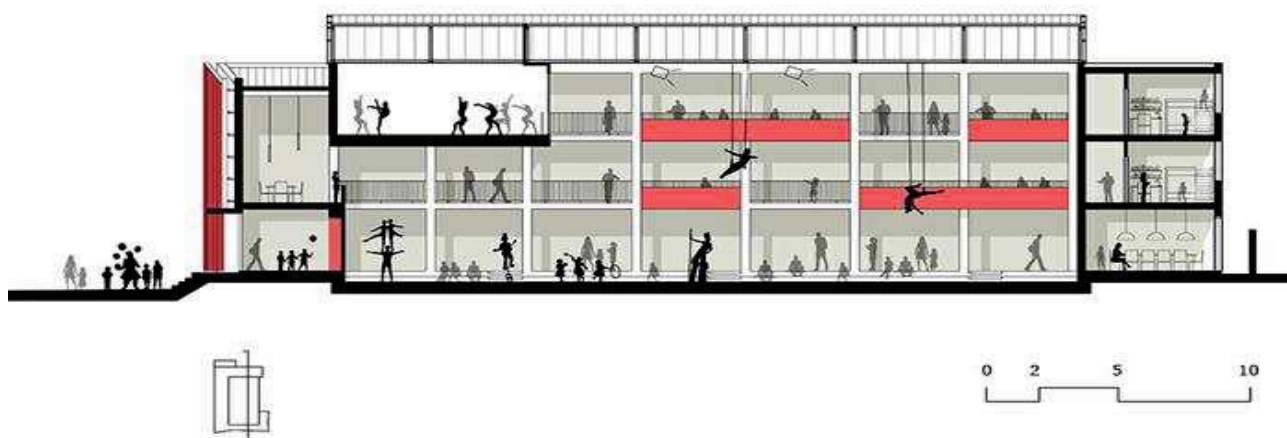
Corte longitudinal arquitectónico del proyecto
